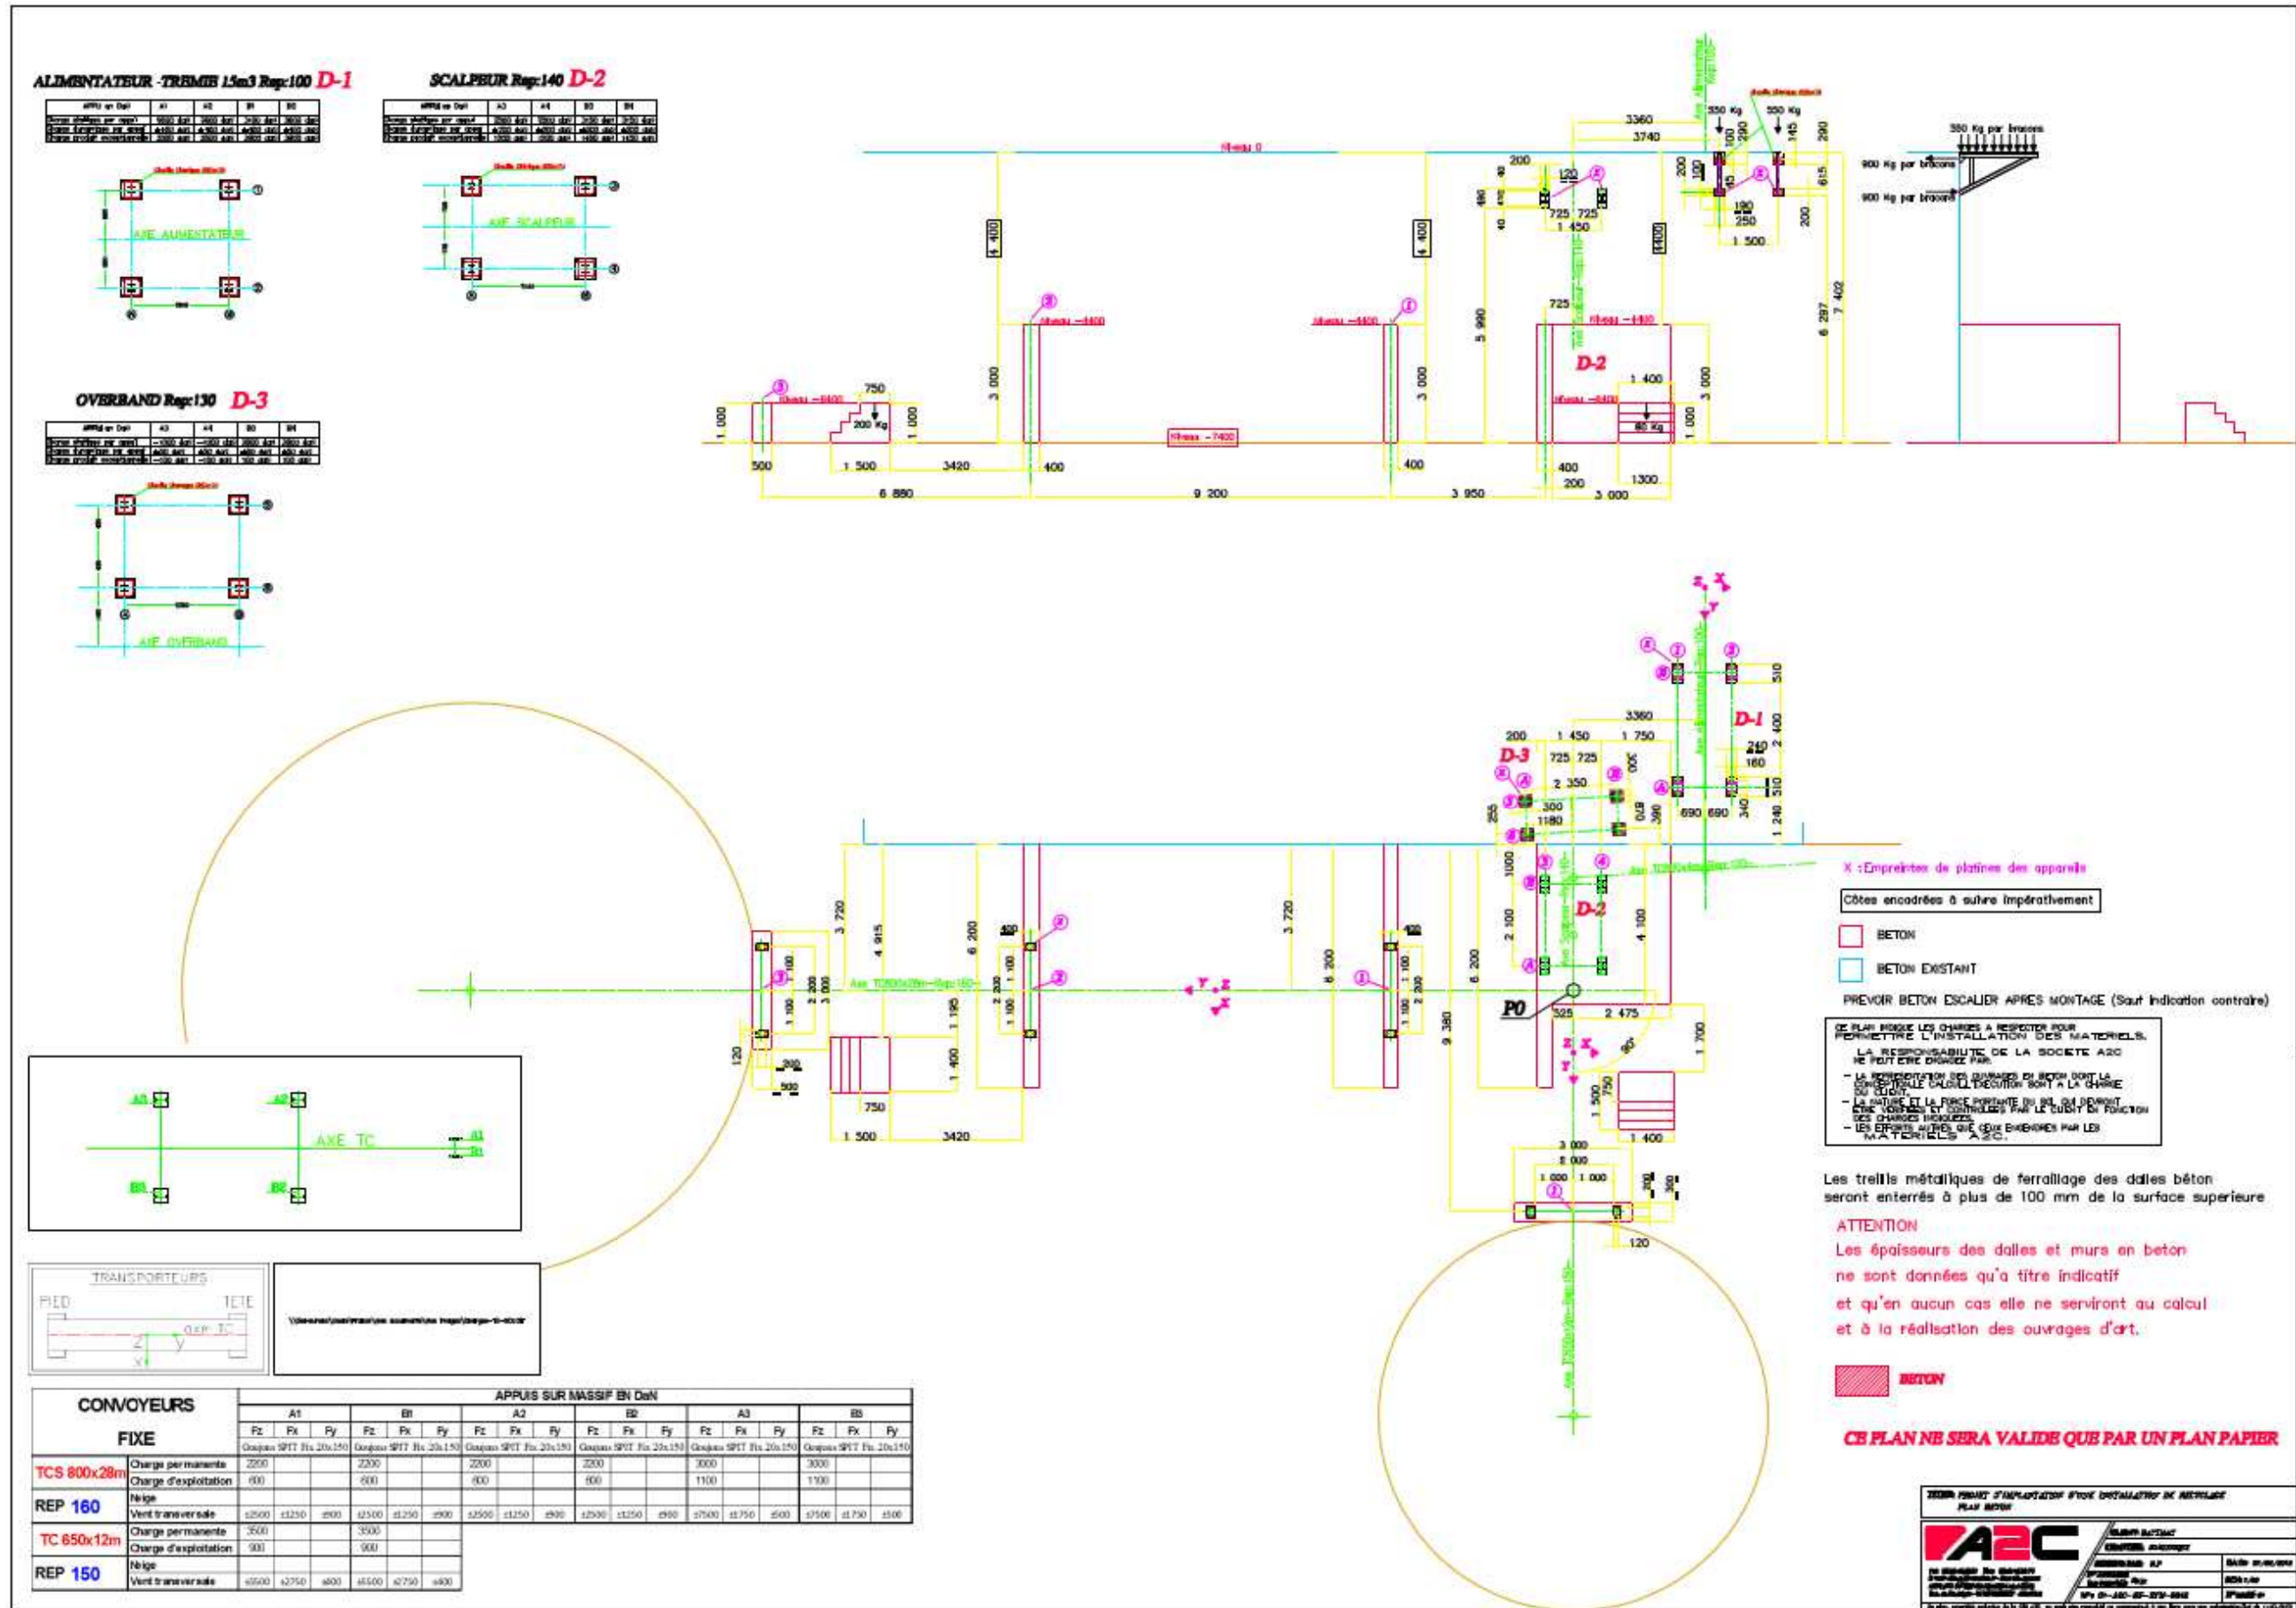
Schéma de la nouvelle installation de tri (2/2) – Plan béton
